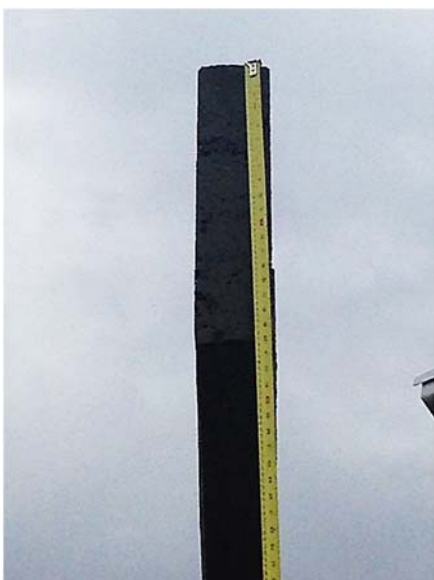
Detalhe da ponta da Viga Transversal - Medição *in loco*.
